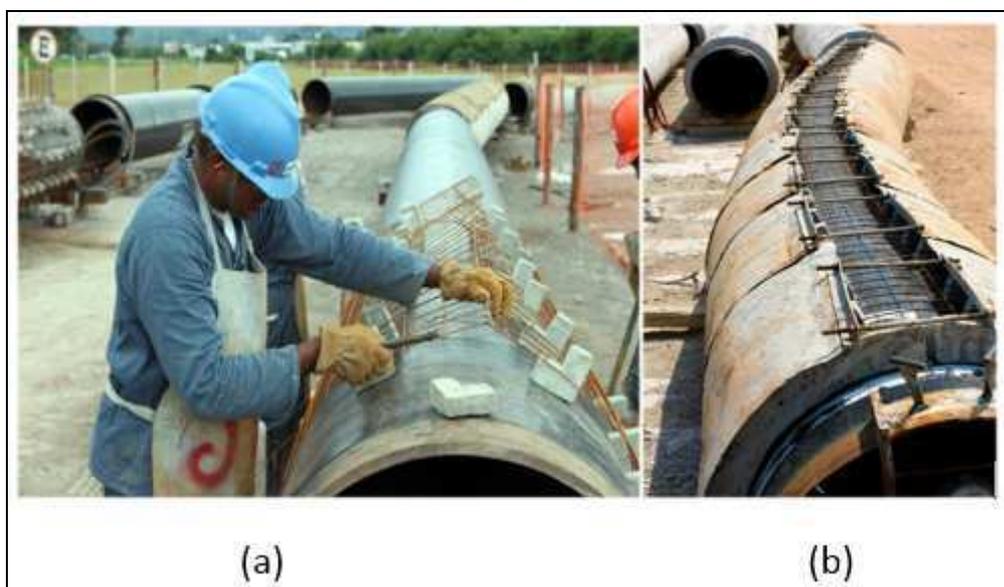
(a) Instalação de armadura de tela nos tubos. (b) Armadura de tela instalada no tubo (PETROBRAS, 2017).
